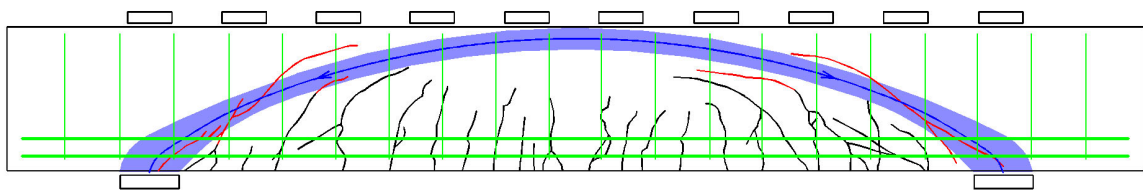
Balken B 6 mit überlagerter Druckparabel und zugehörigen Rissen
